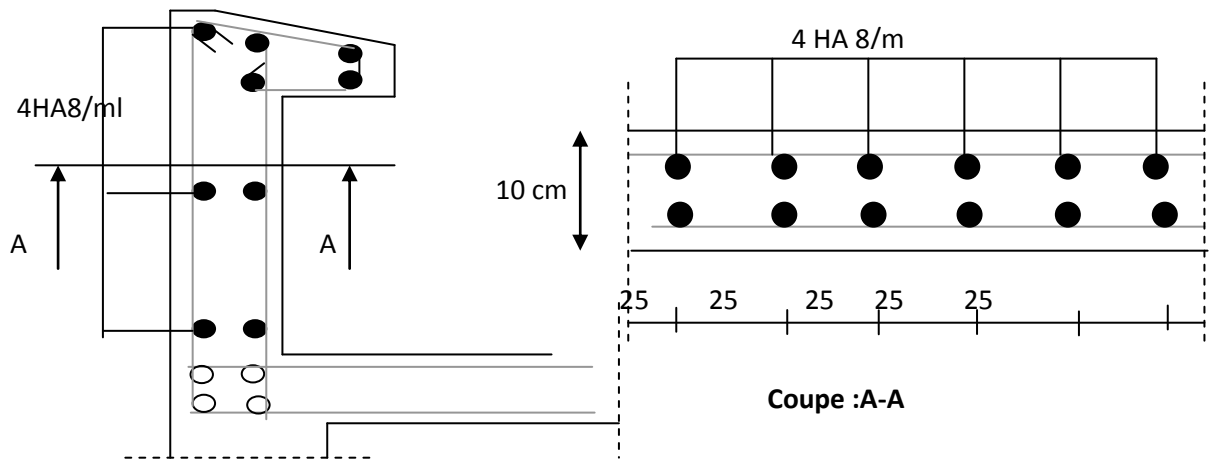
Schéma du ferrailage et coffrage de l'acrotère
